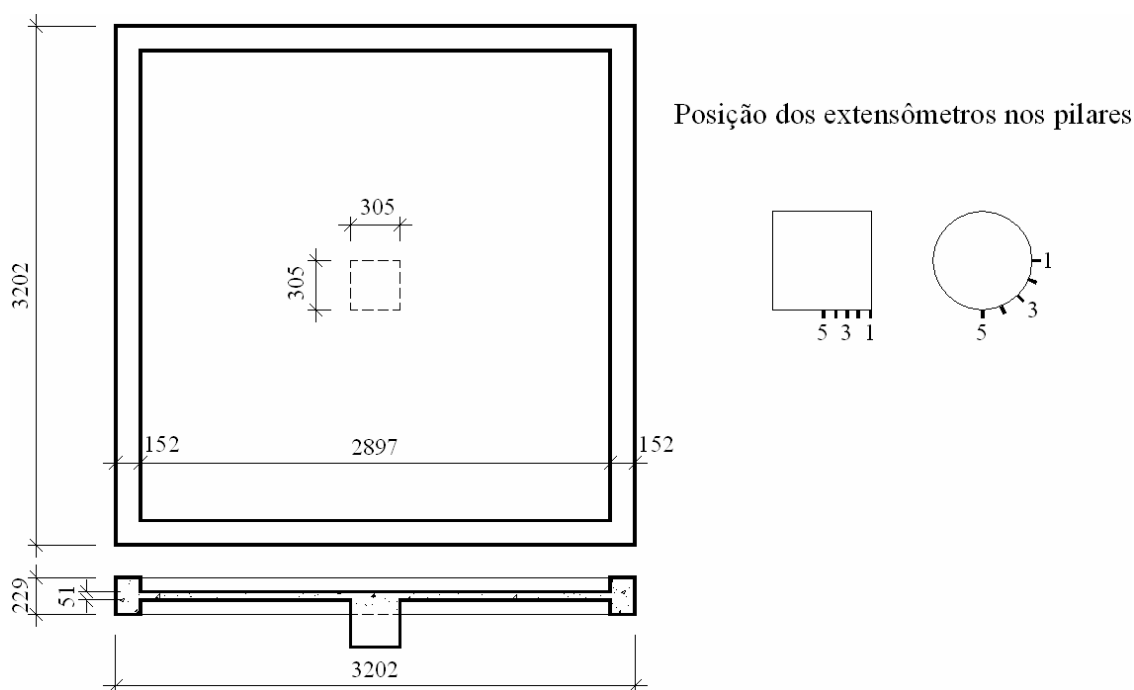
Detalhe das lajes ensaiadas por Vanderbilt (1972)
